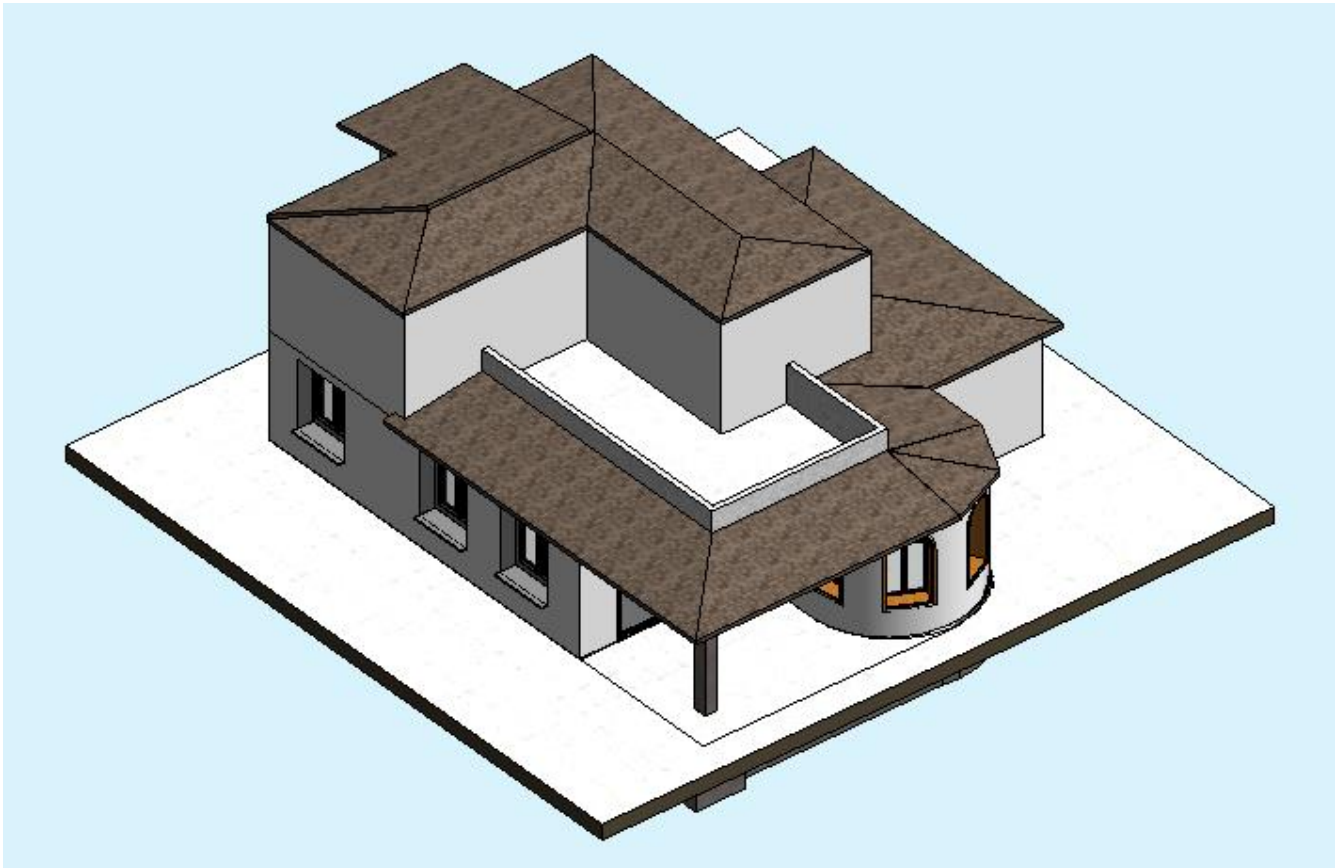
Modelado del proyecto “Ceste 68” con Autodesk® Revit™2016. Alzados Sur y Oeste
